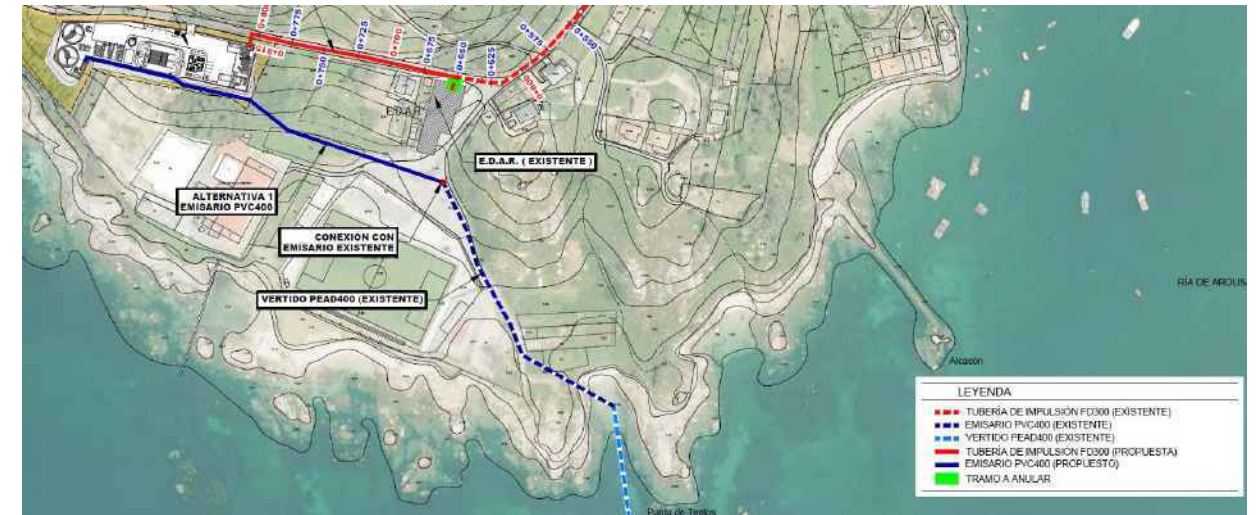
Planta general de salida de agua tratada. Alternativa 1
